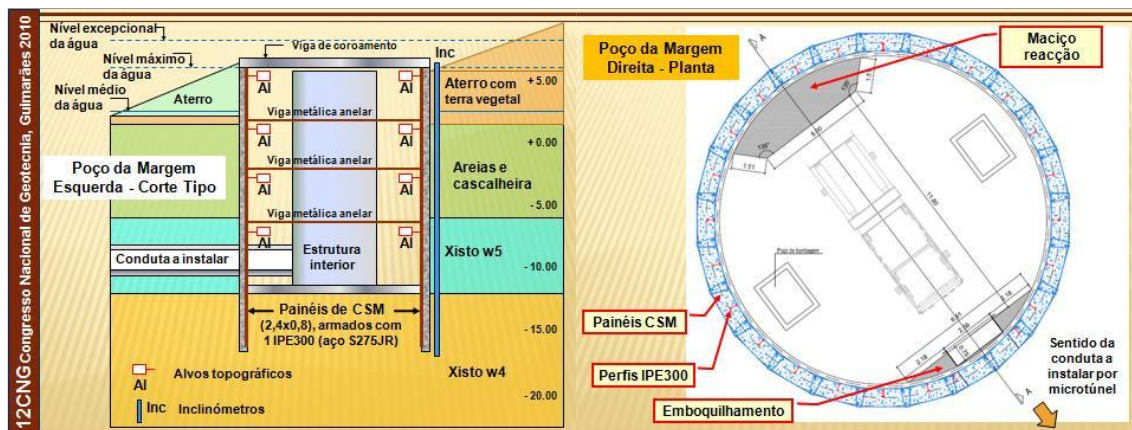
Corte tipo e planta das soluções estudadas e implementadas
